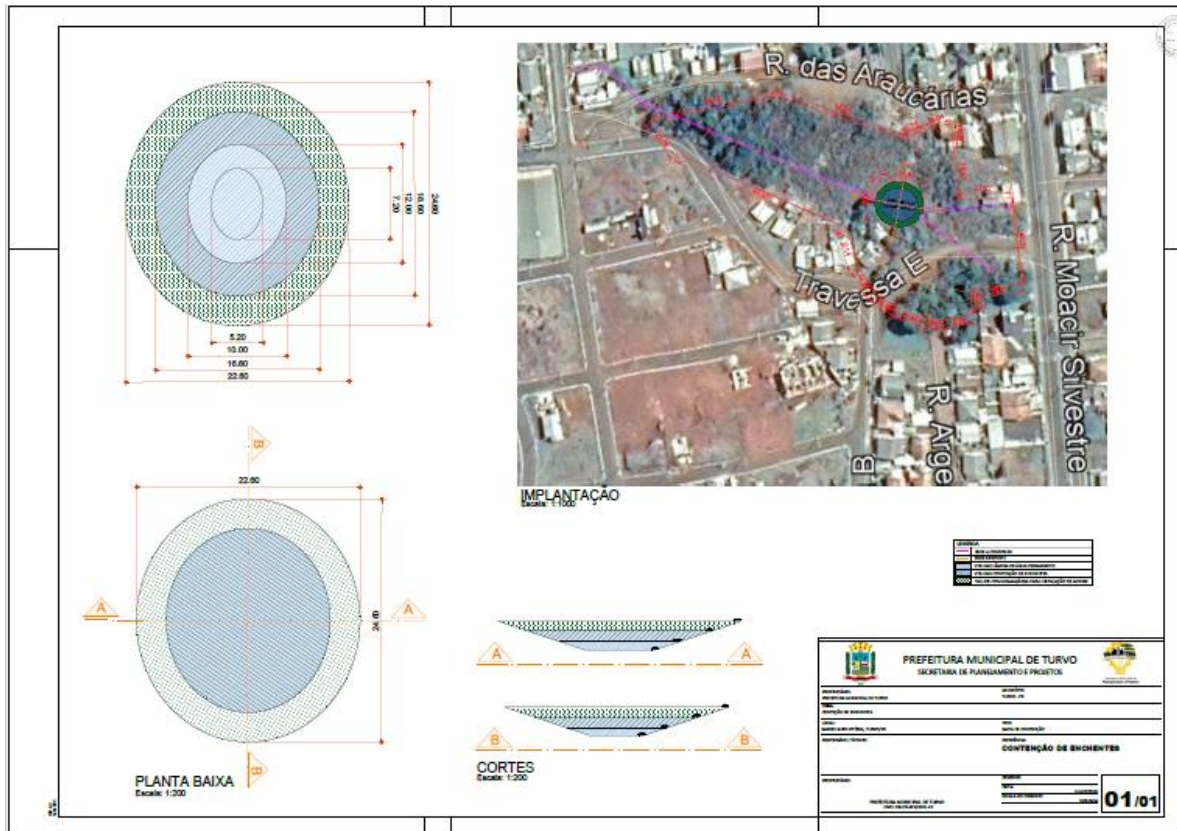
Croqui do projeto da Bacia de Contenção em fase de execução;
